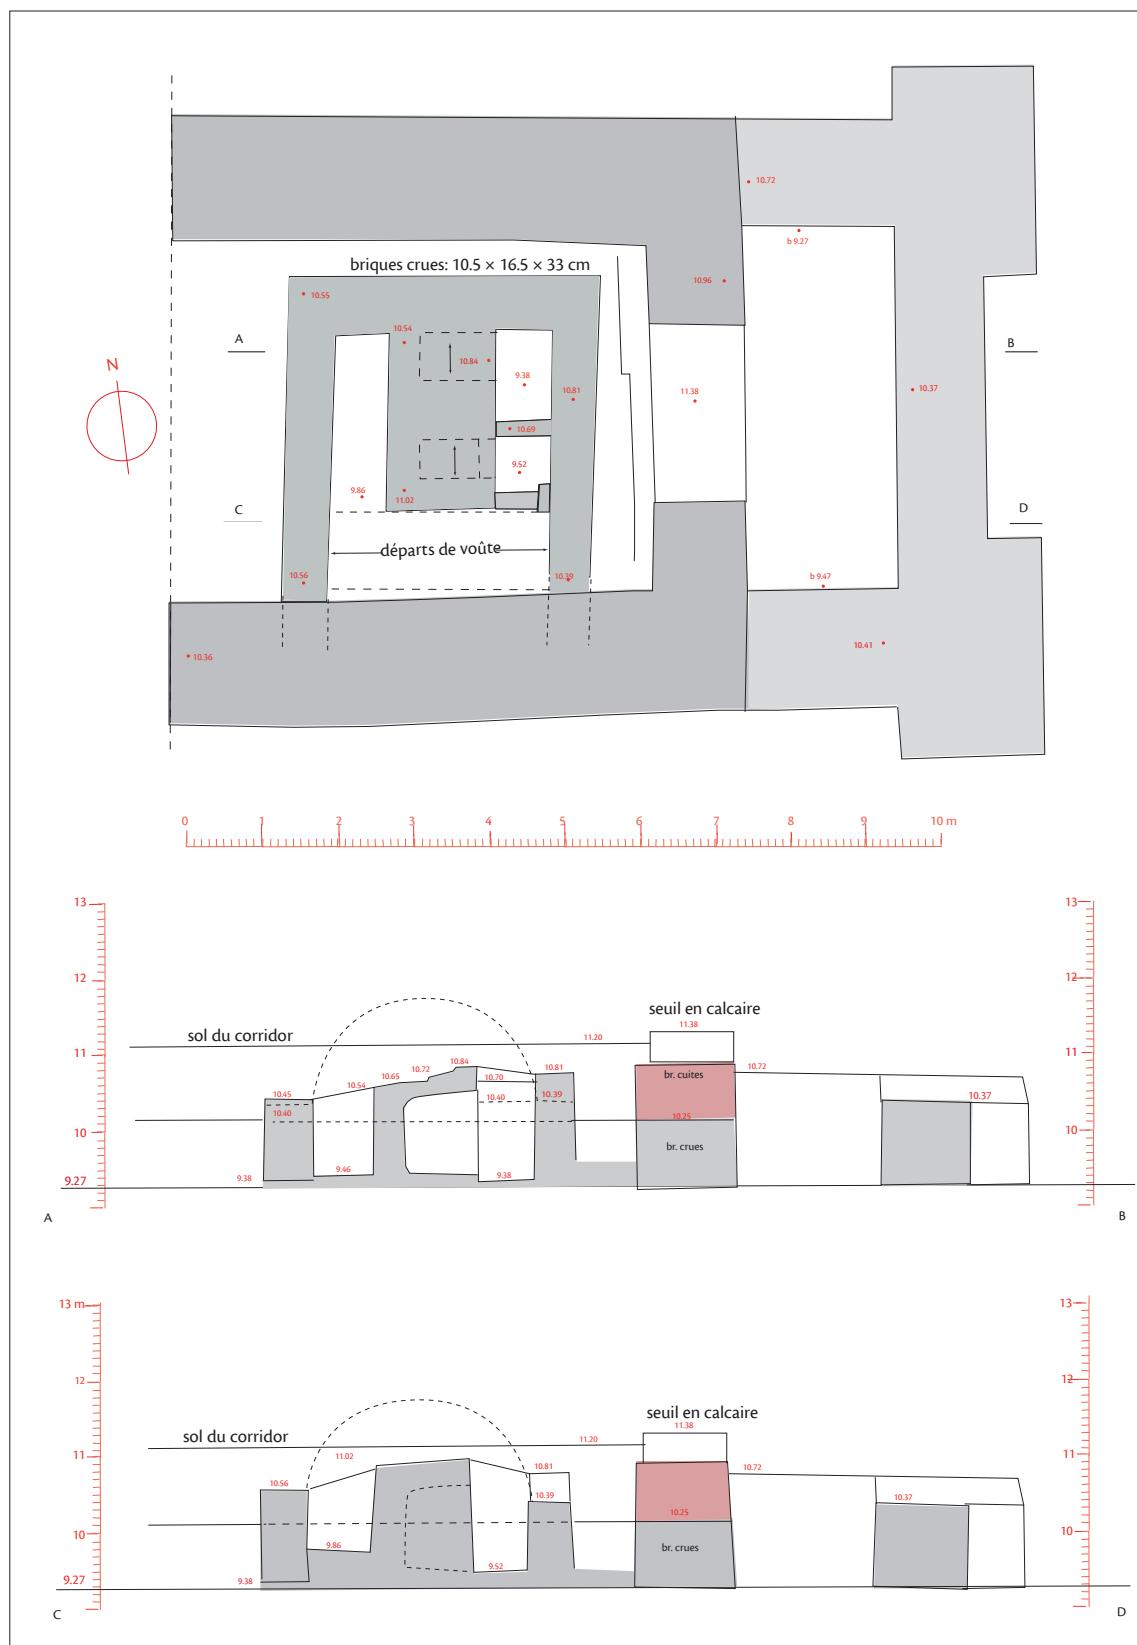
Plan et coupes AB et CD de la salle Ab.
